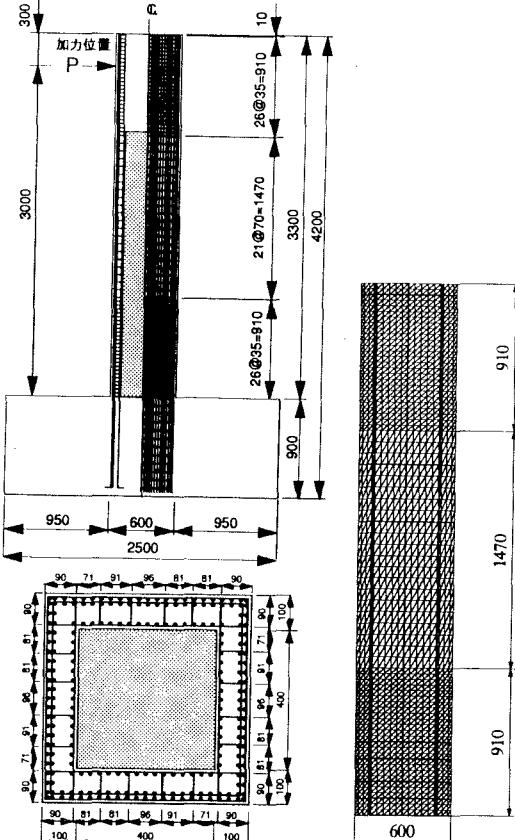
構造諸元及び配筋図(単位:mm) 図-2 要素メッシュ
